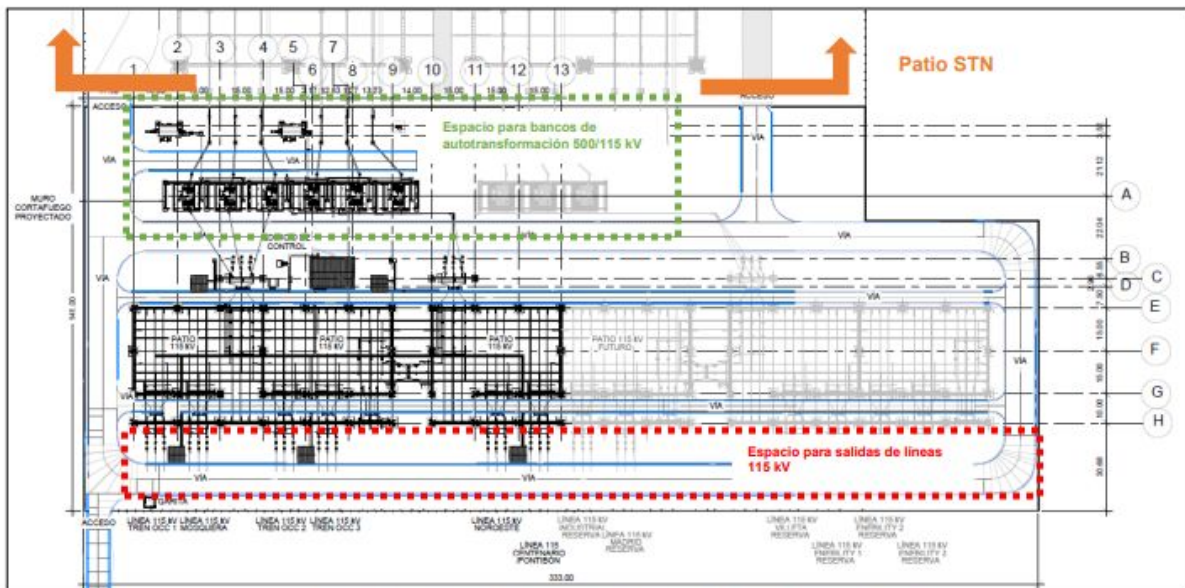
Plantillado Requerimientos espacio del STR proyecto Corzo
